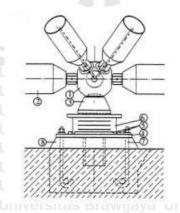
Bantalan penopang Space Frame type basic Sumber: handbook of structural engineering, 2005
